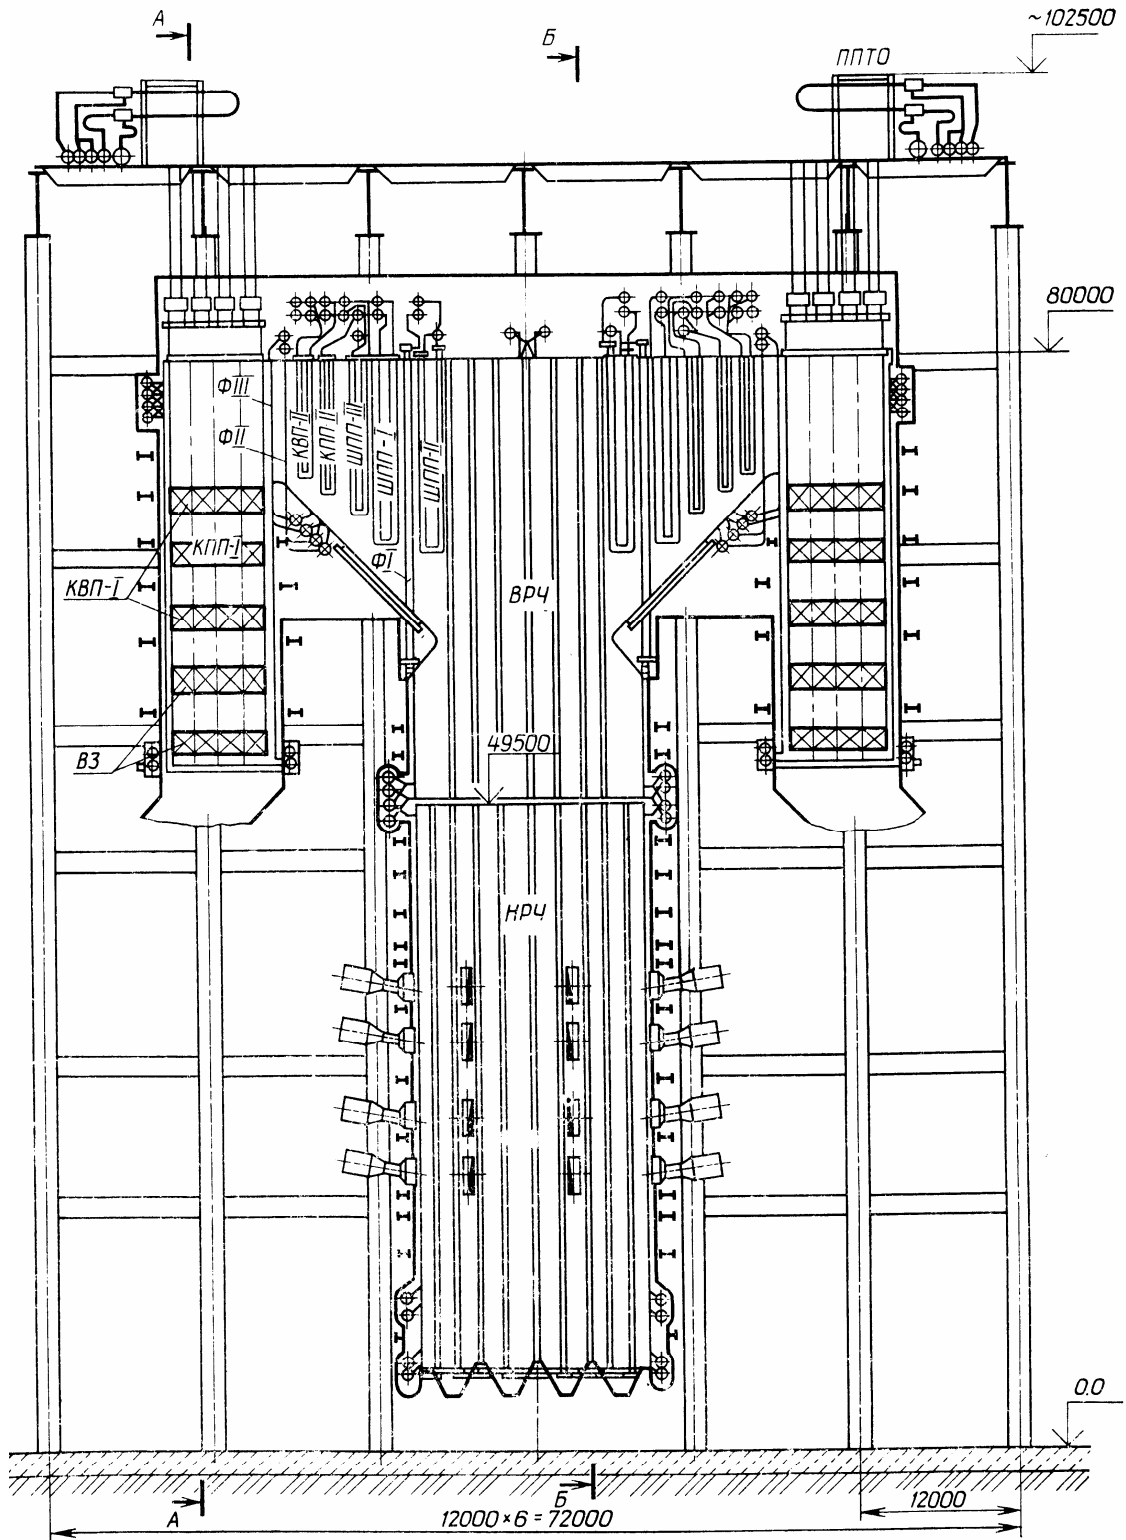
Продольный разрез котла Пп-1650-25-545 БТ (П-78)
